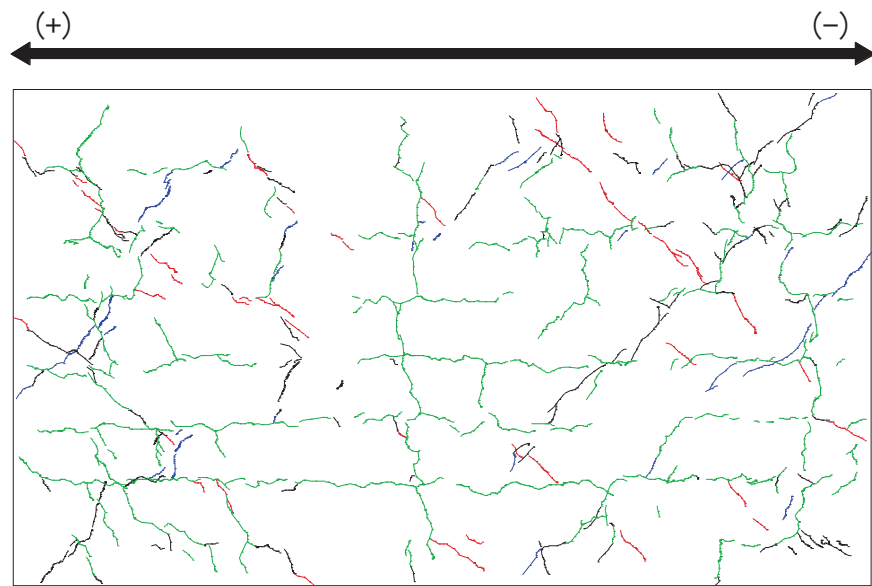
(6) 乾燥試験体 [2] 1/1667rad. におけるひび割れ図
